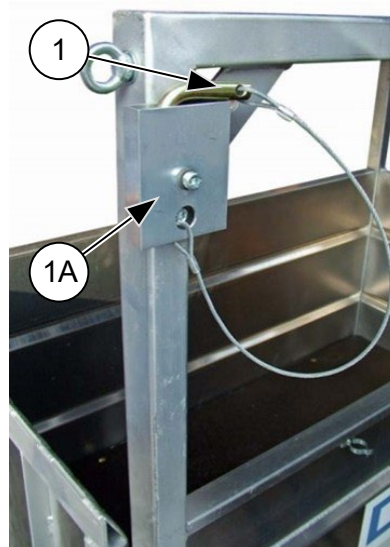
Drzwi bezpieczeństwa pięter "ECO+" z plandeką
